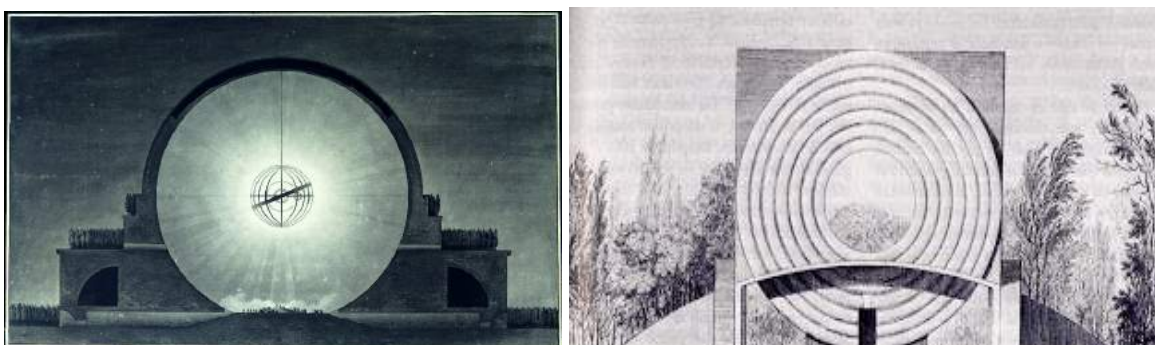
Cenotafio de Newton. Louis Boullée y proyecto para una tonelería de Ledoux.
